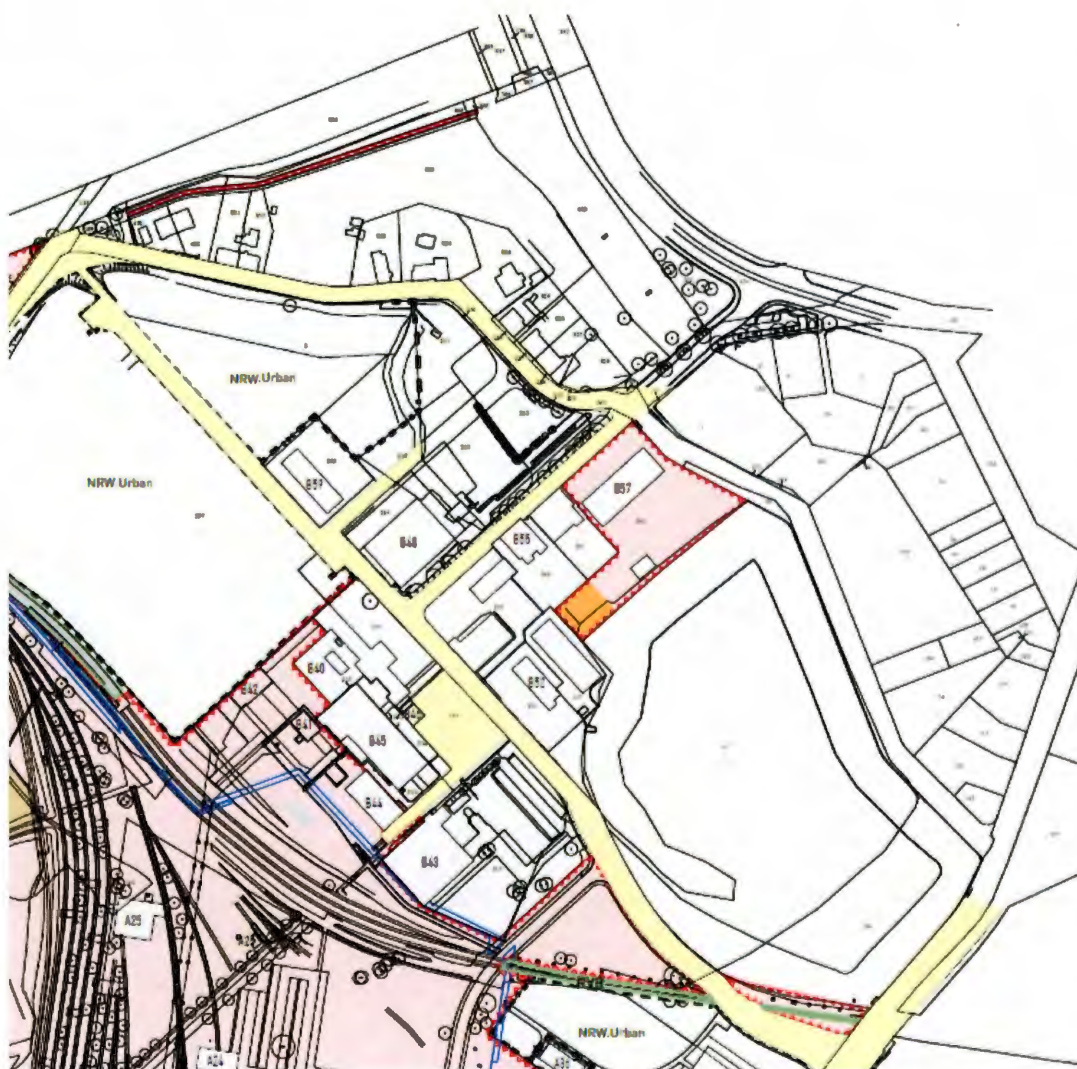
La zone des puits 1/2/8.* Source image : *Stiftung Zollverein* (La Fondation Zollverein).
